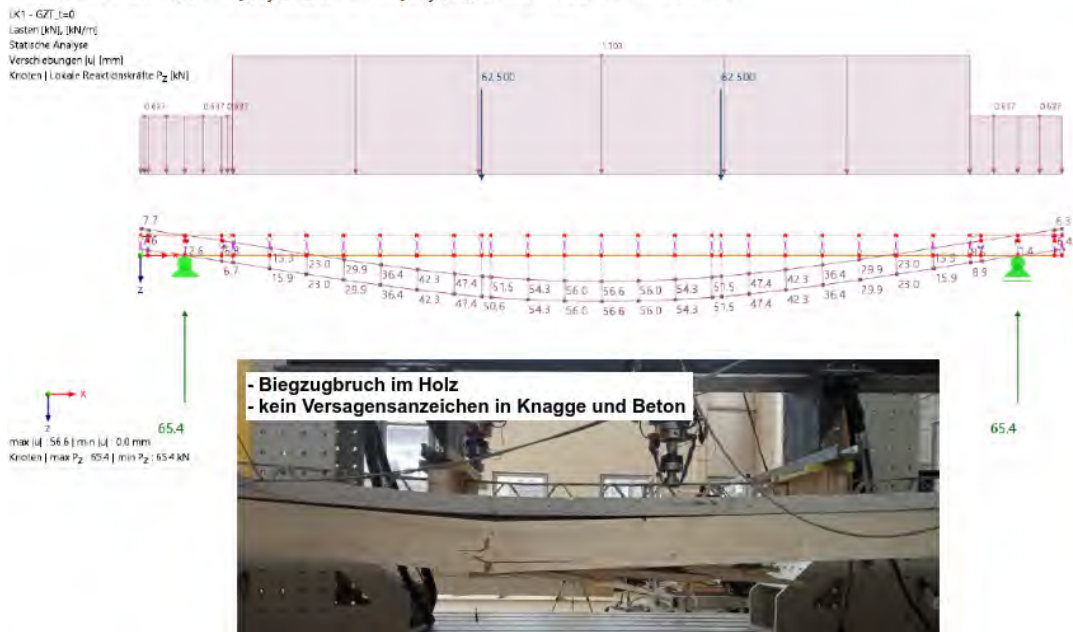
Oben: Rechenmodell unter Bruchlast (Durchbiegung 57mm). Unten: Foto aus dem Laborversuch nach Bruch.
